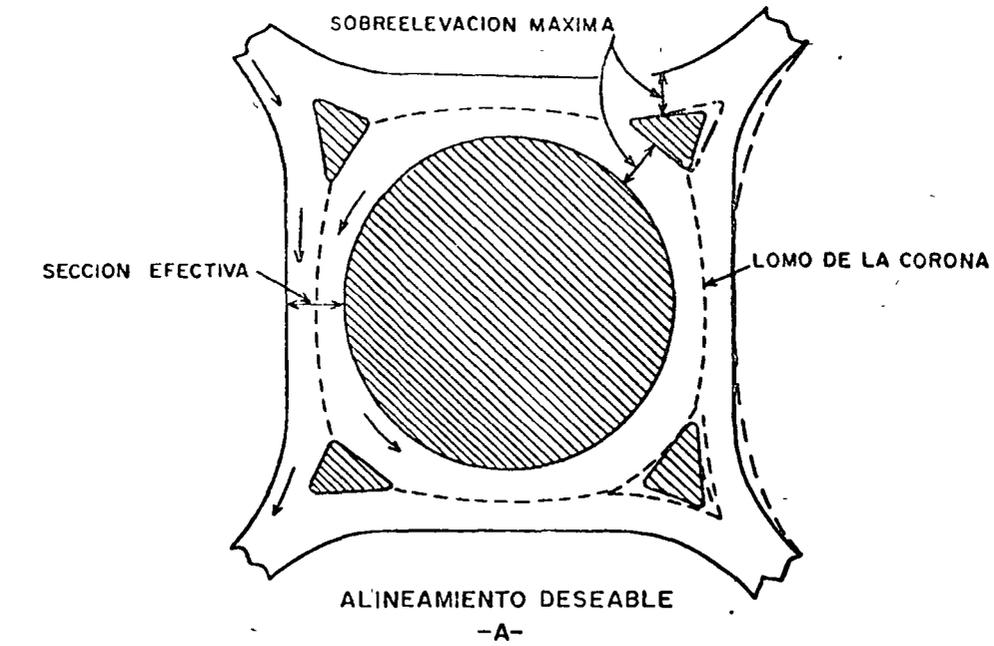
ALINEAMIENTO DE LA CALZADA DE LA GLORIETA
